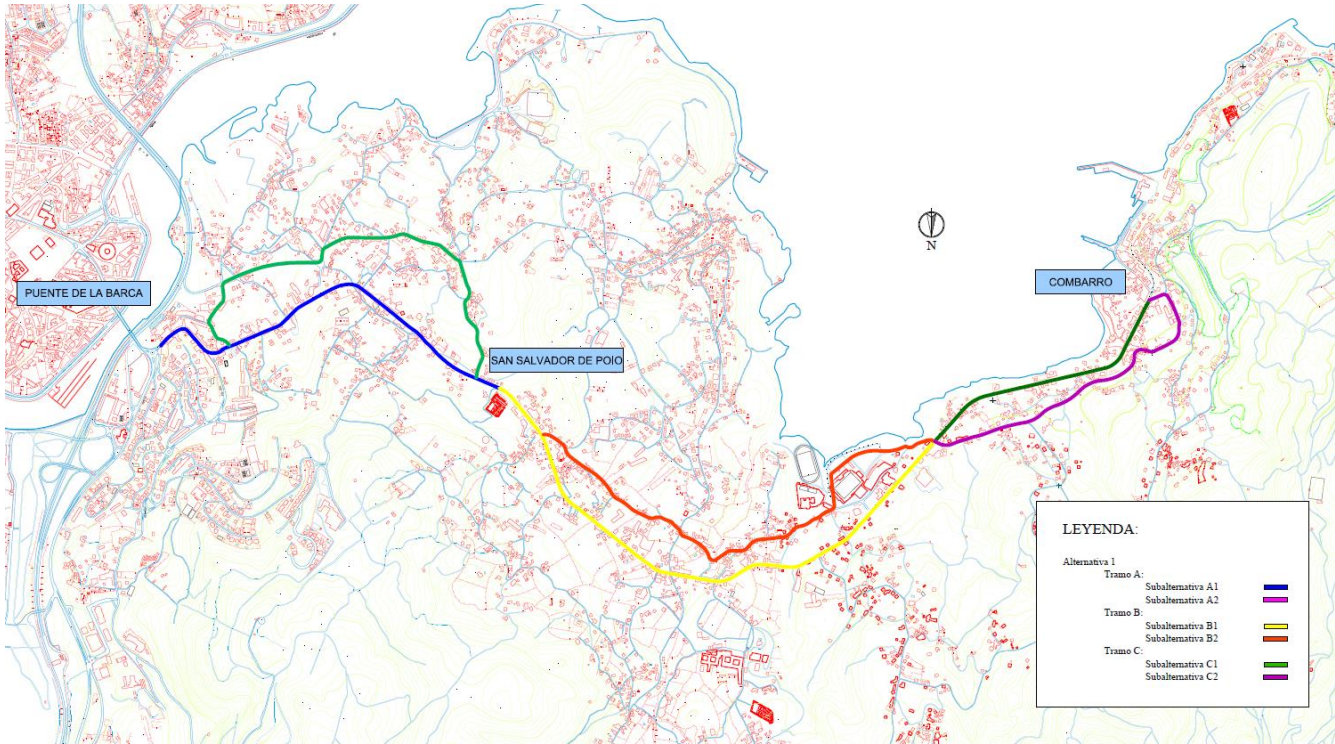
Planta General de las subalternativas de la Alternativa 1
